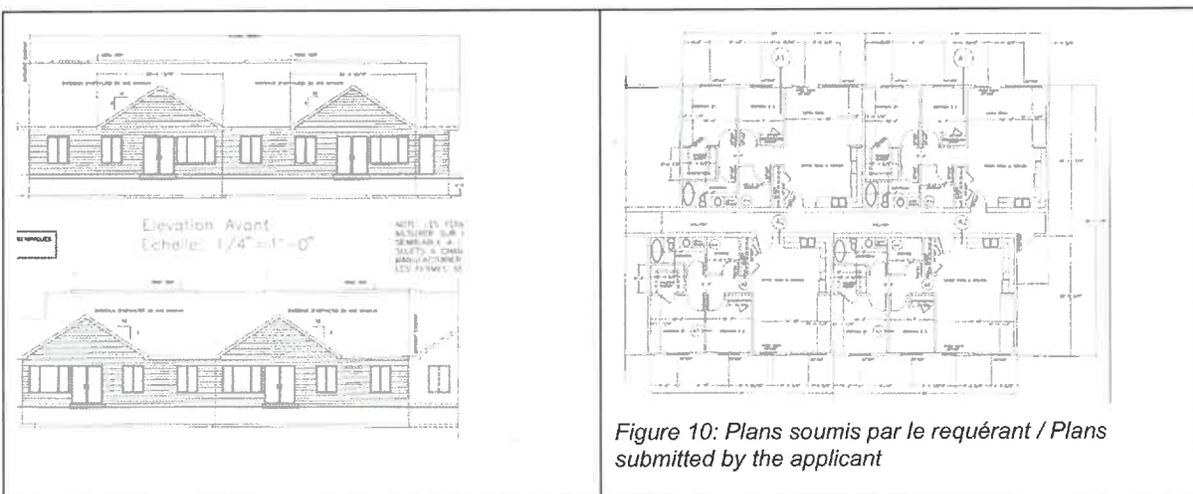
Plans soumis par le requérant / Plans submitted by the applicant
